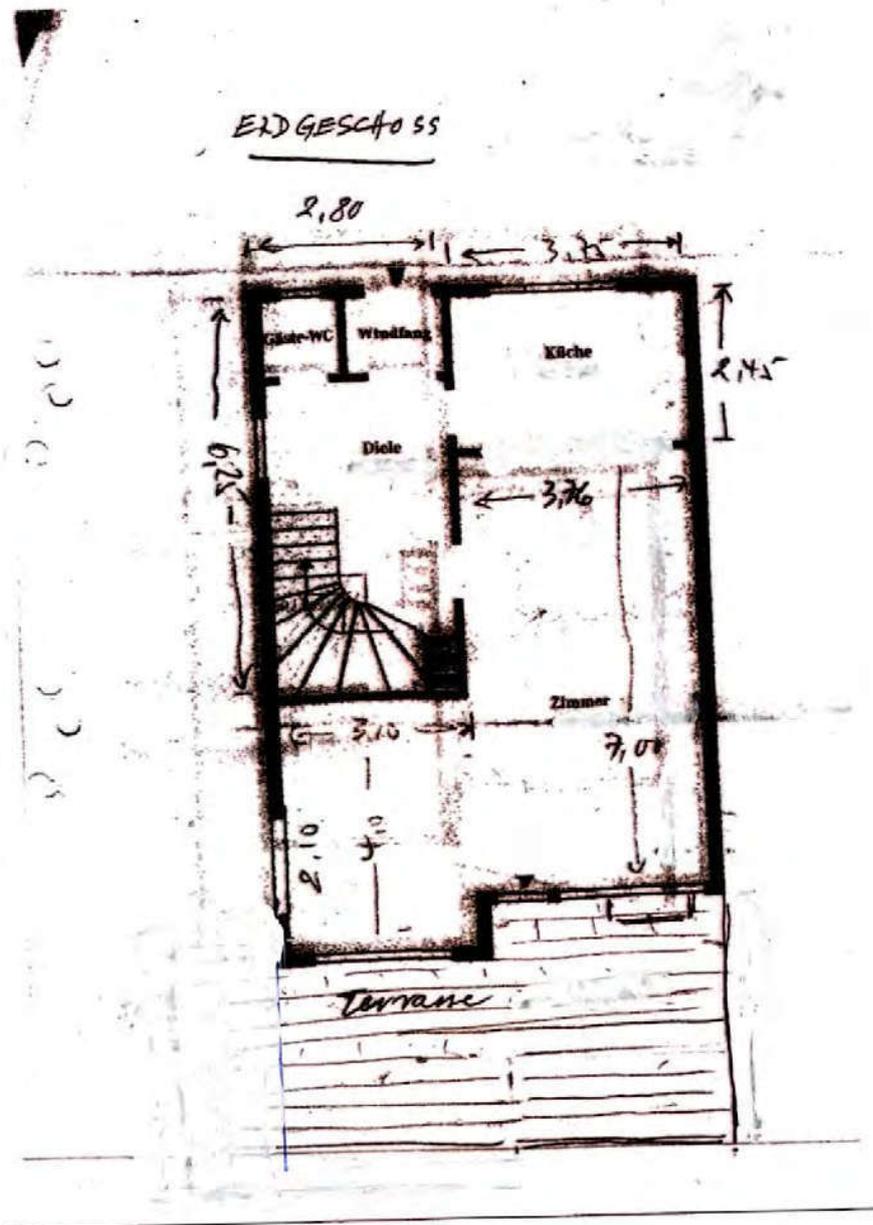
Grundriss EG (kein Originalgrundriss für das Bewertungsobjekt, ggf. mit Abweichungen, Vermaßungen wurden nicht geprüft)
